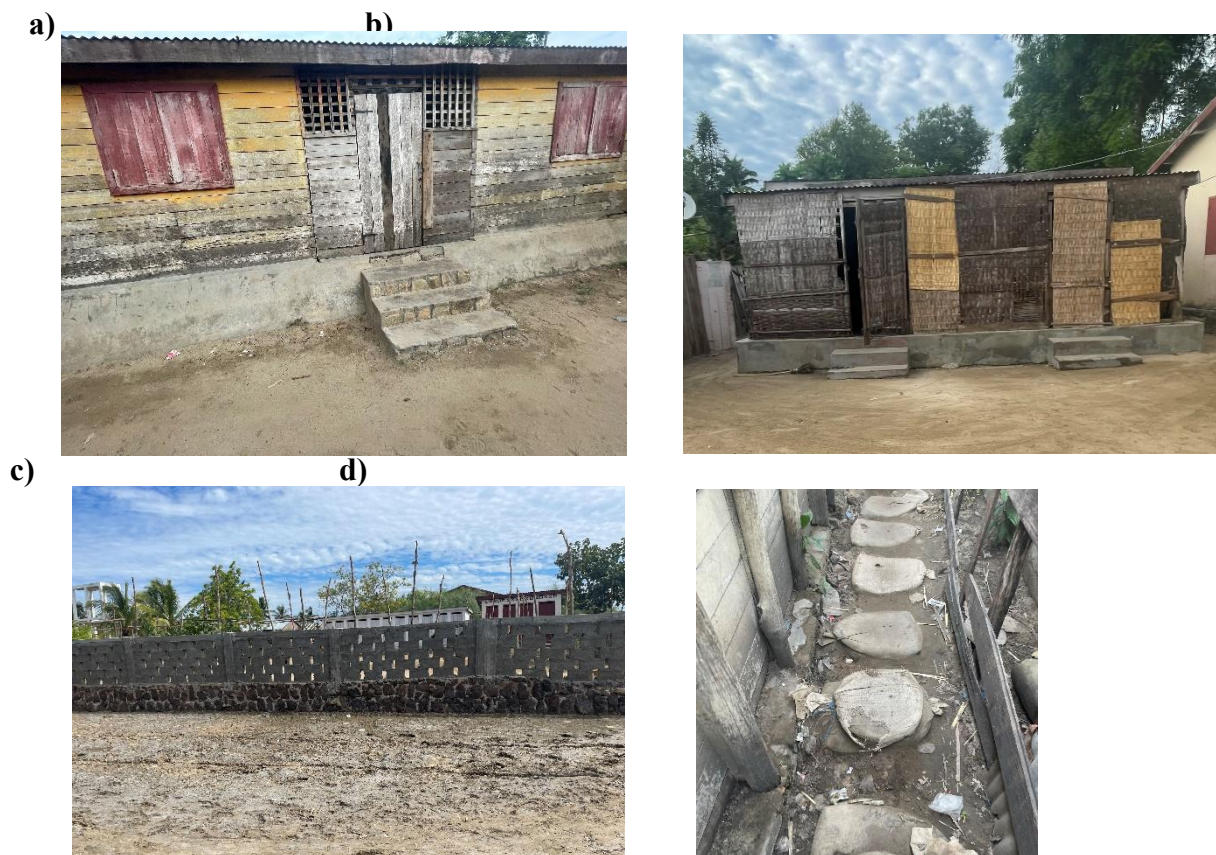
renforcement de la fondation d’habitat en planche (a) ; renforcement de la fondation d’habitat en paillotte (b) ; renforcement de la fondation de la clôture d’un habitat en dur (c) ;
